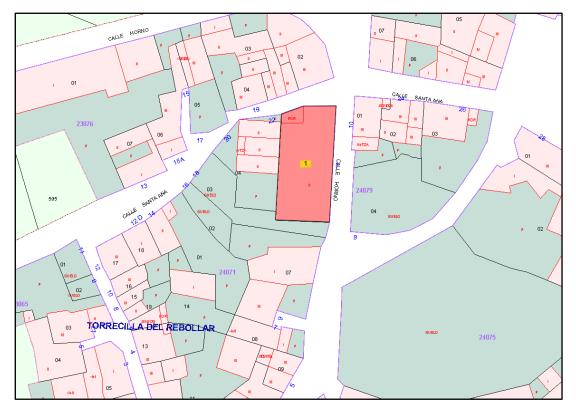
Plano de emplazamiento del Edificio objeto del informe.
